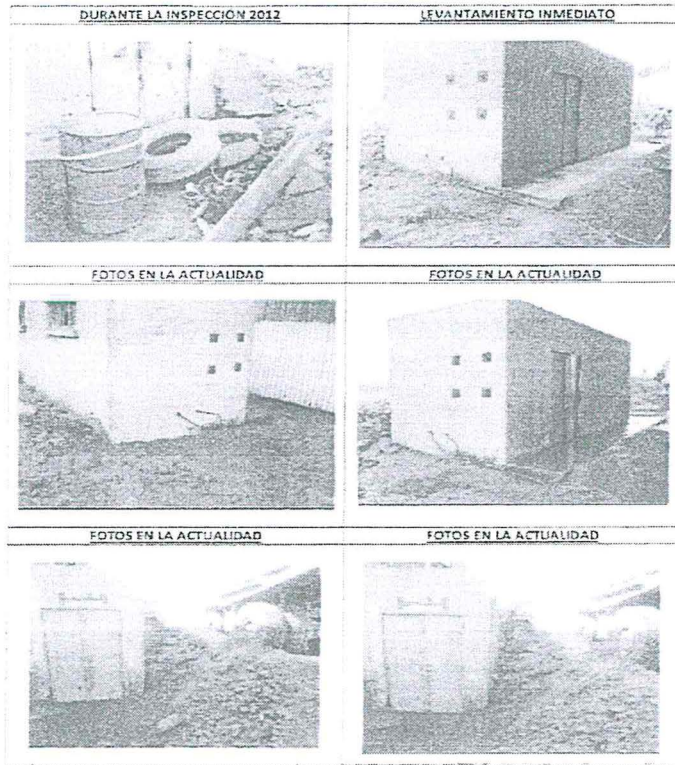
Alrededores de la Planta Chancadora 2 – Área Mina
